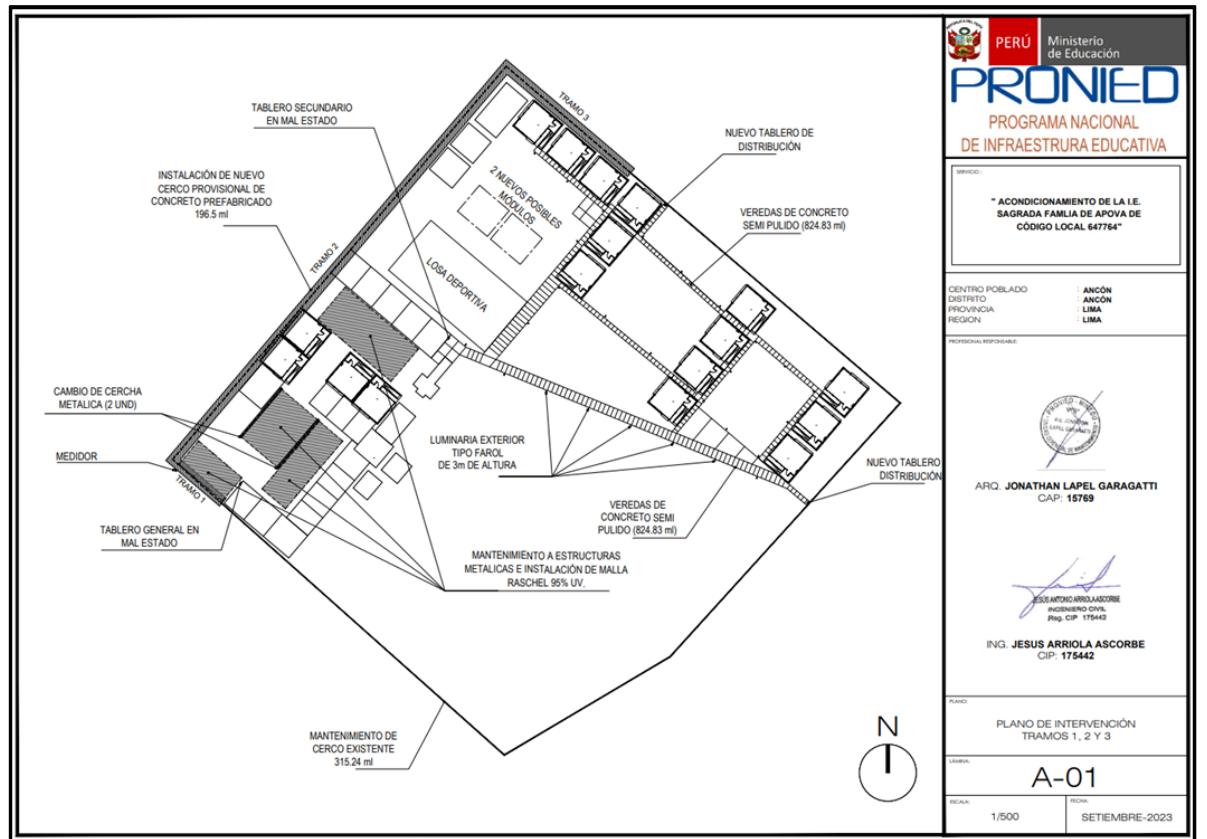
Plano de levantamiento de infraestructura en riesgo
